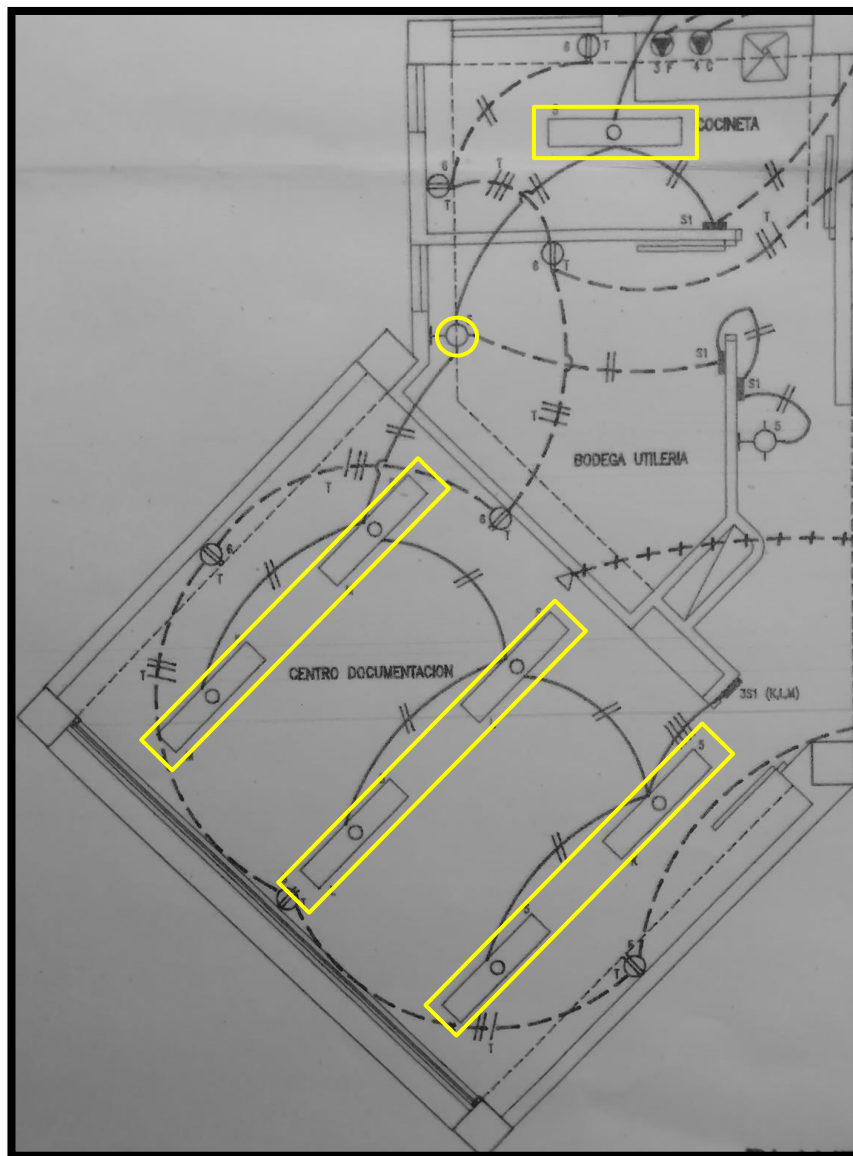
Cornare. (2008). Plano de Distribución del Sistema Eléctrico Planta Tercer Piso.
